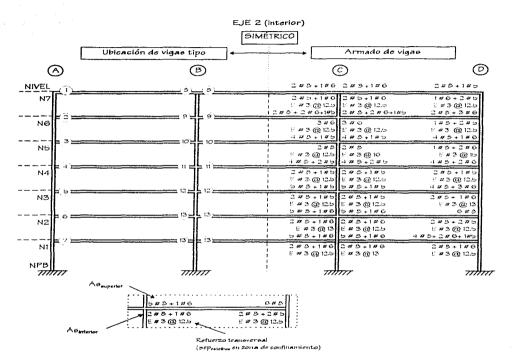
Ubicación de tipos de armados de vigas del eje 2 de la estructura disefiada en la zona II
